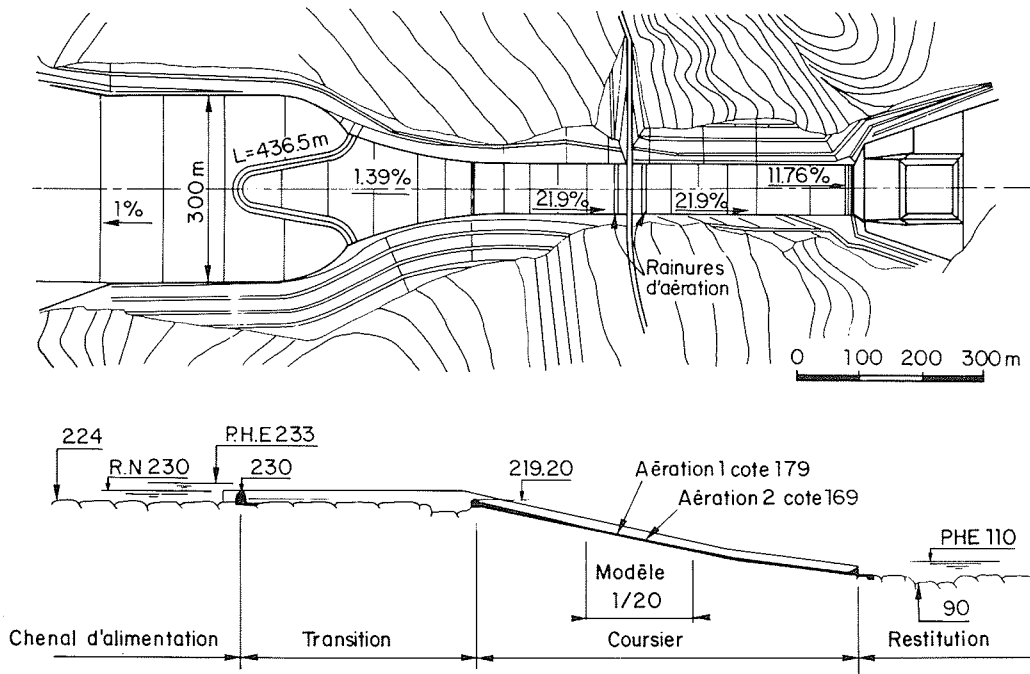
Evacuateur – Vue en plan et coupe longitudinale
